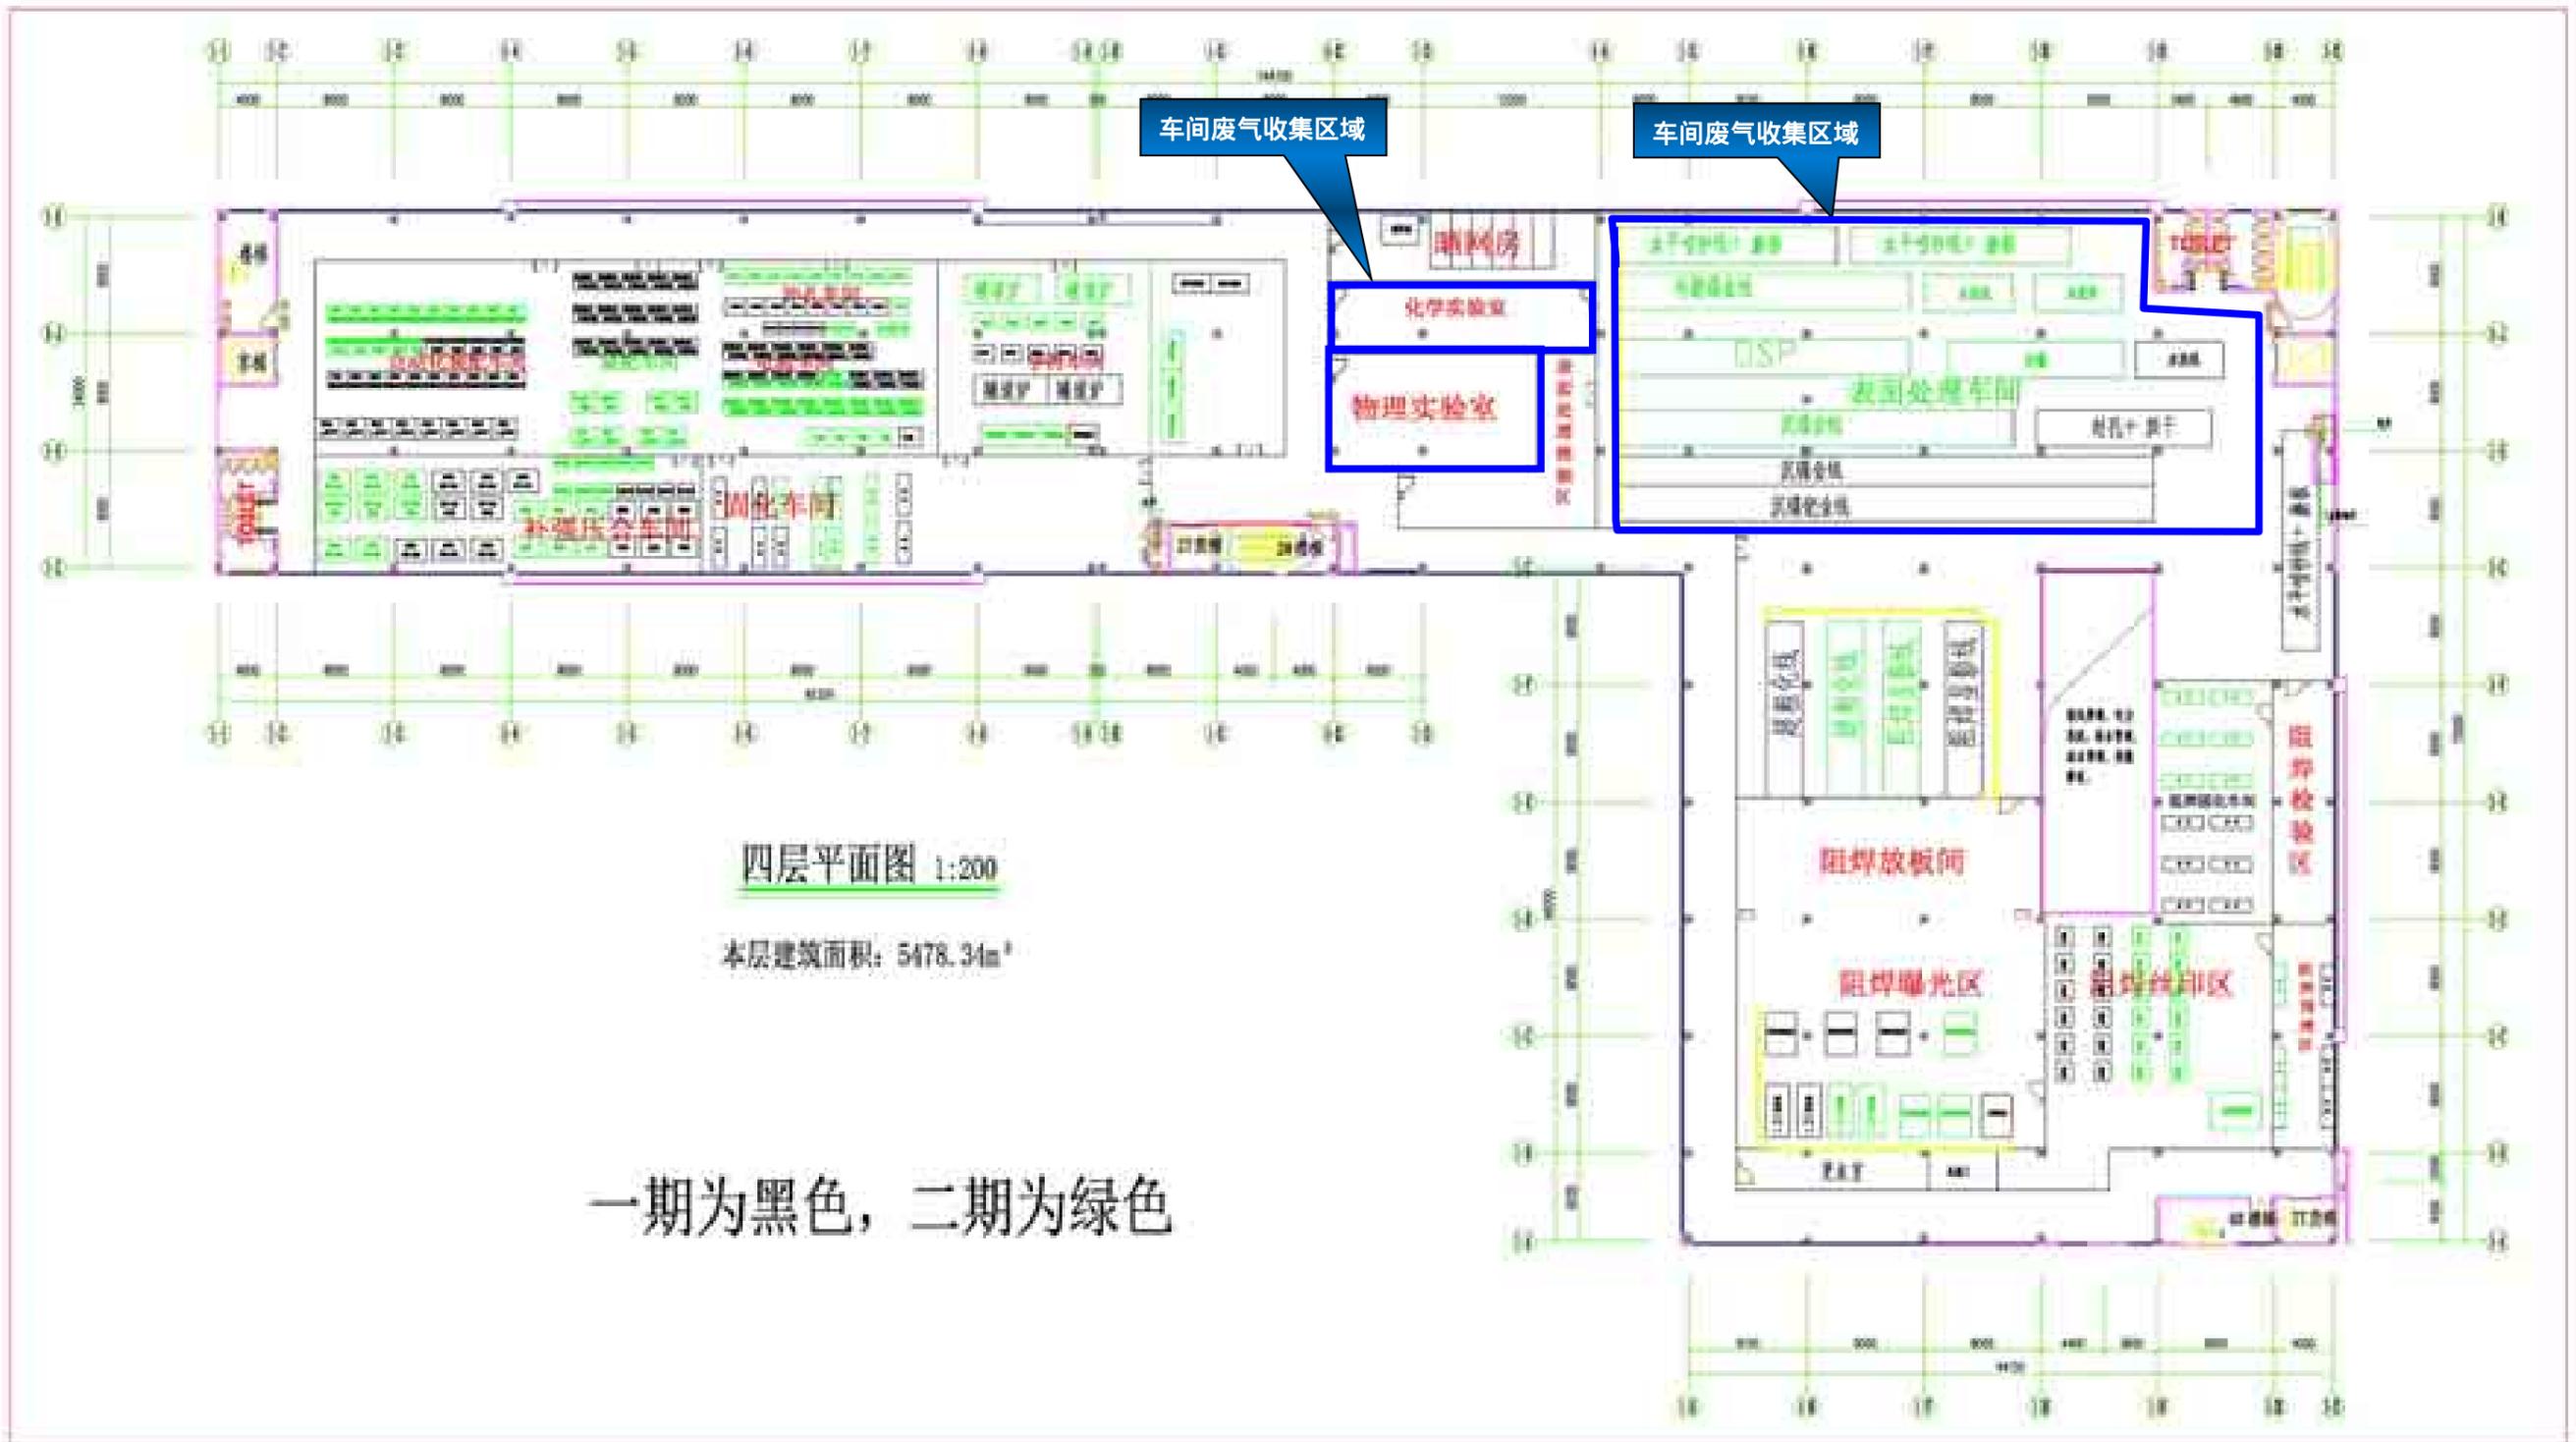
(d) 本项目 1# 厂房平面布置图 (四层)
